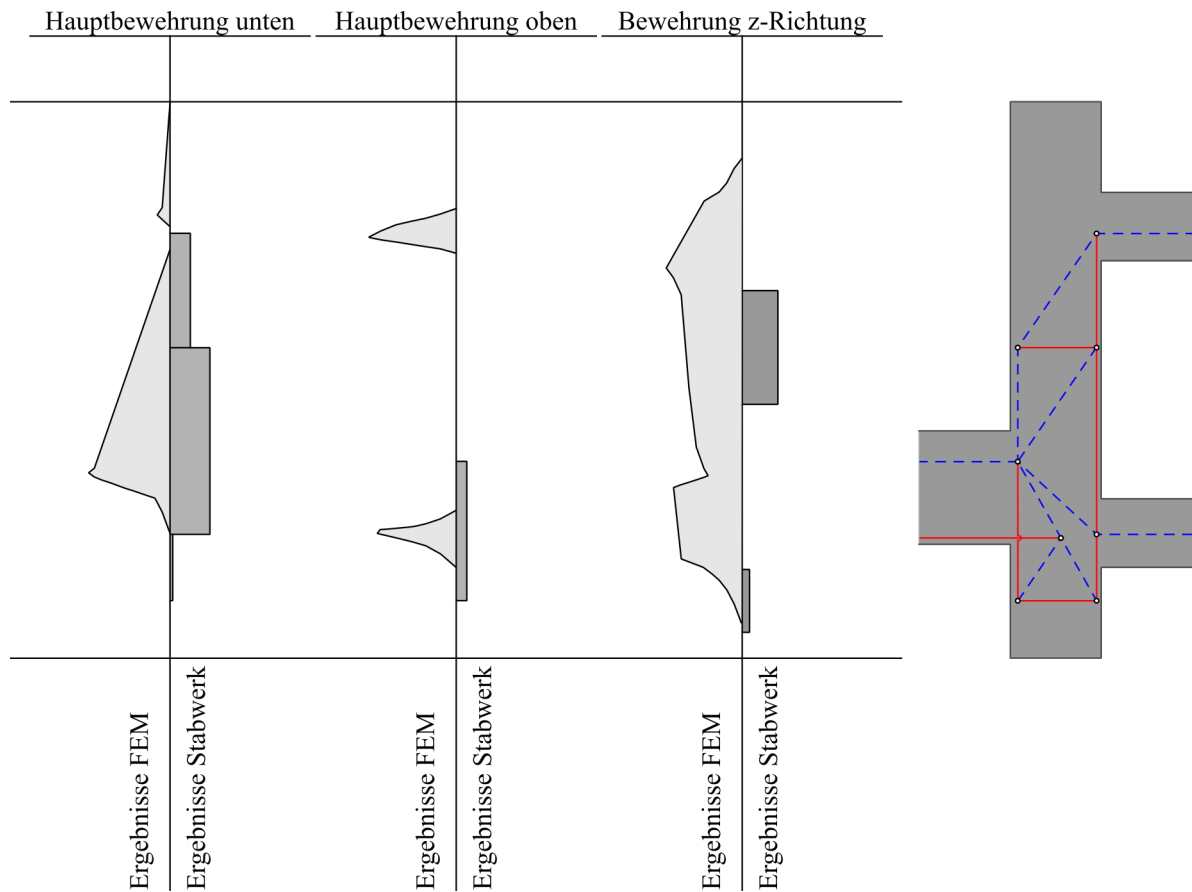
Variante 1 Lastfall 2 - Bewehrungsvergleich
